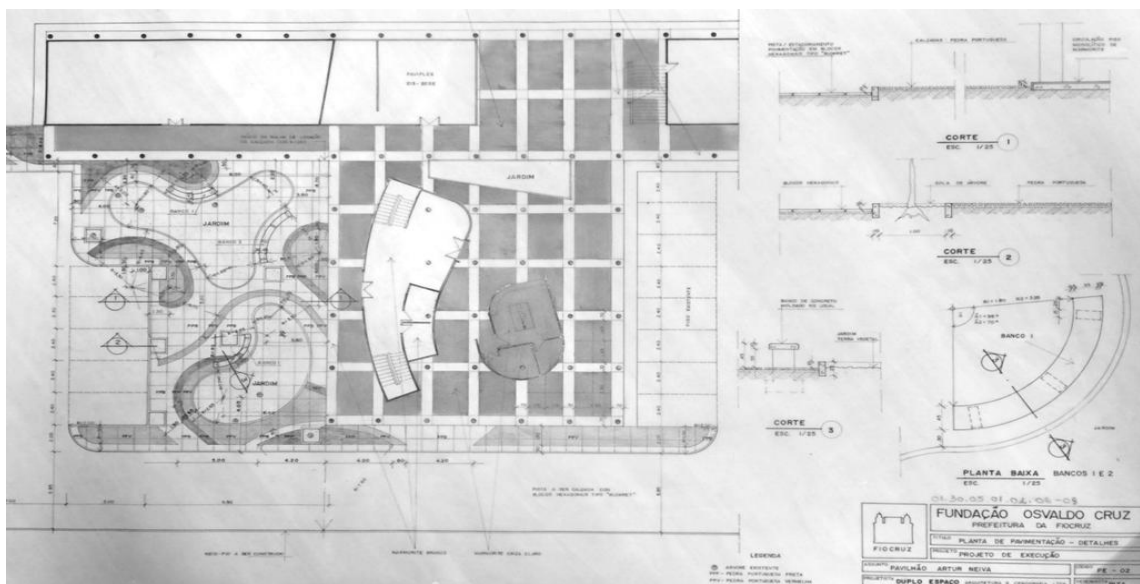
Planta de Pavimentação, 1989 (Fonte: DAD/Fiocruz)
